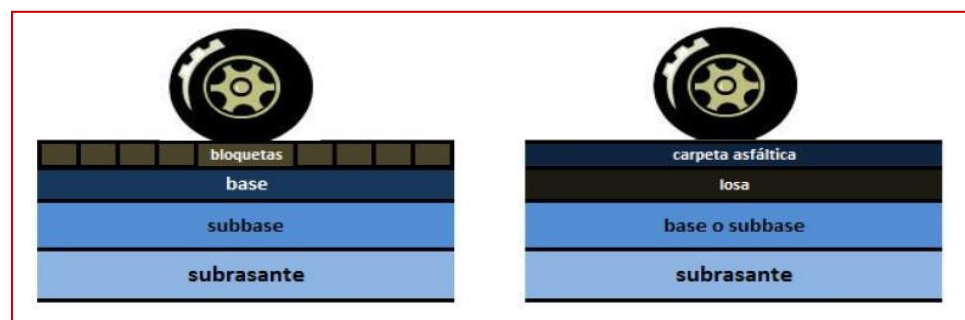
Esquema típico de paquete estructural de pavimentos mixtos.
